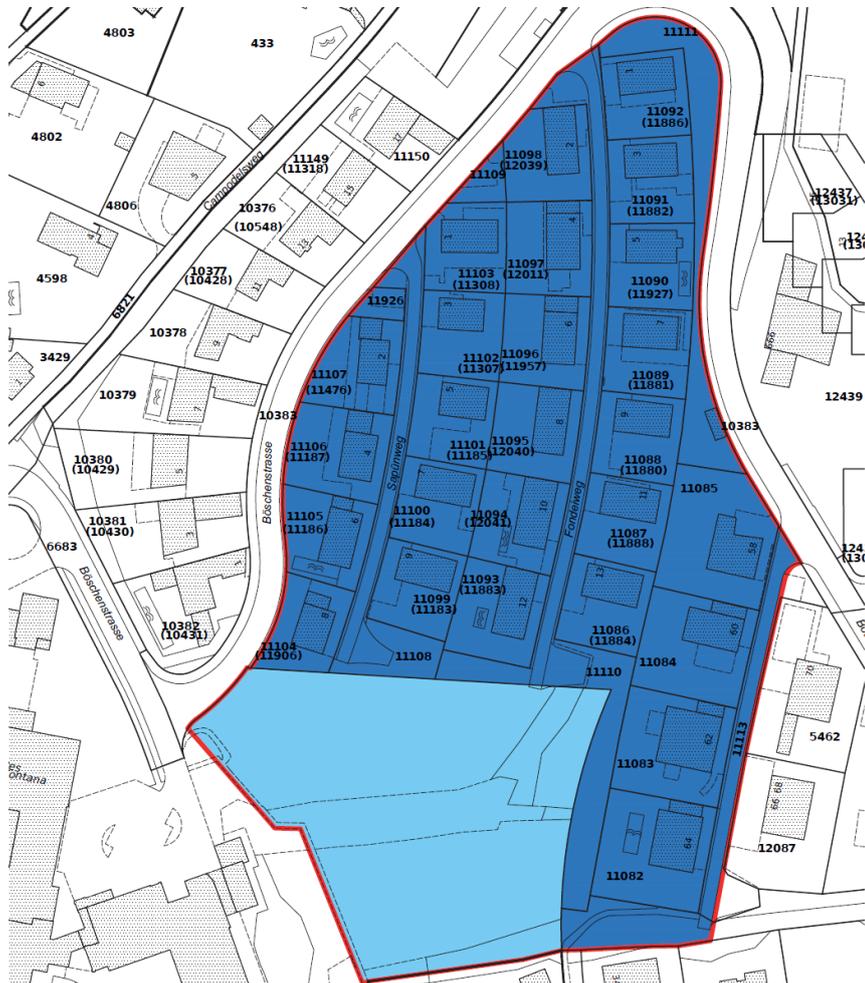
Situationsplan Projektentwurf augenBLICK
